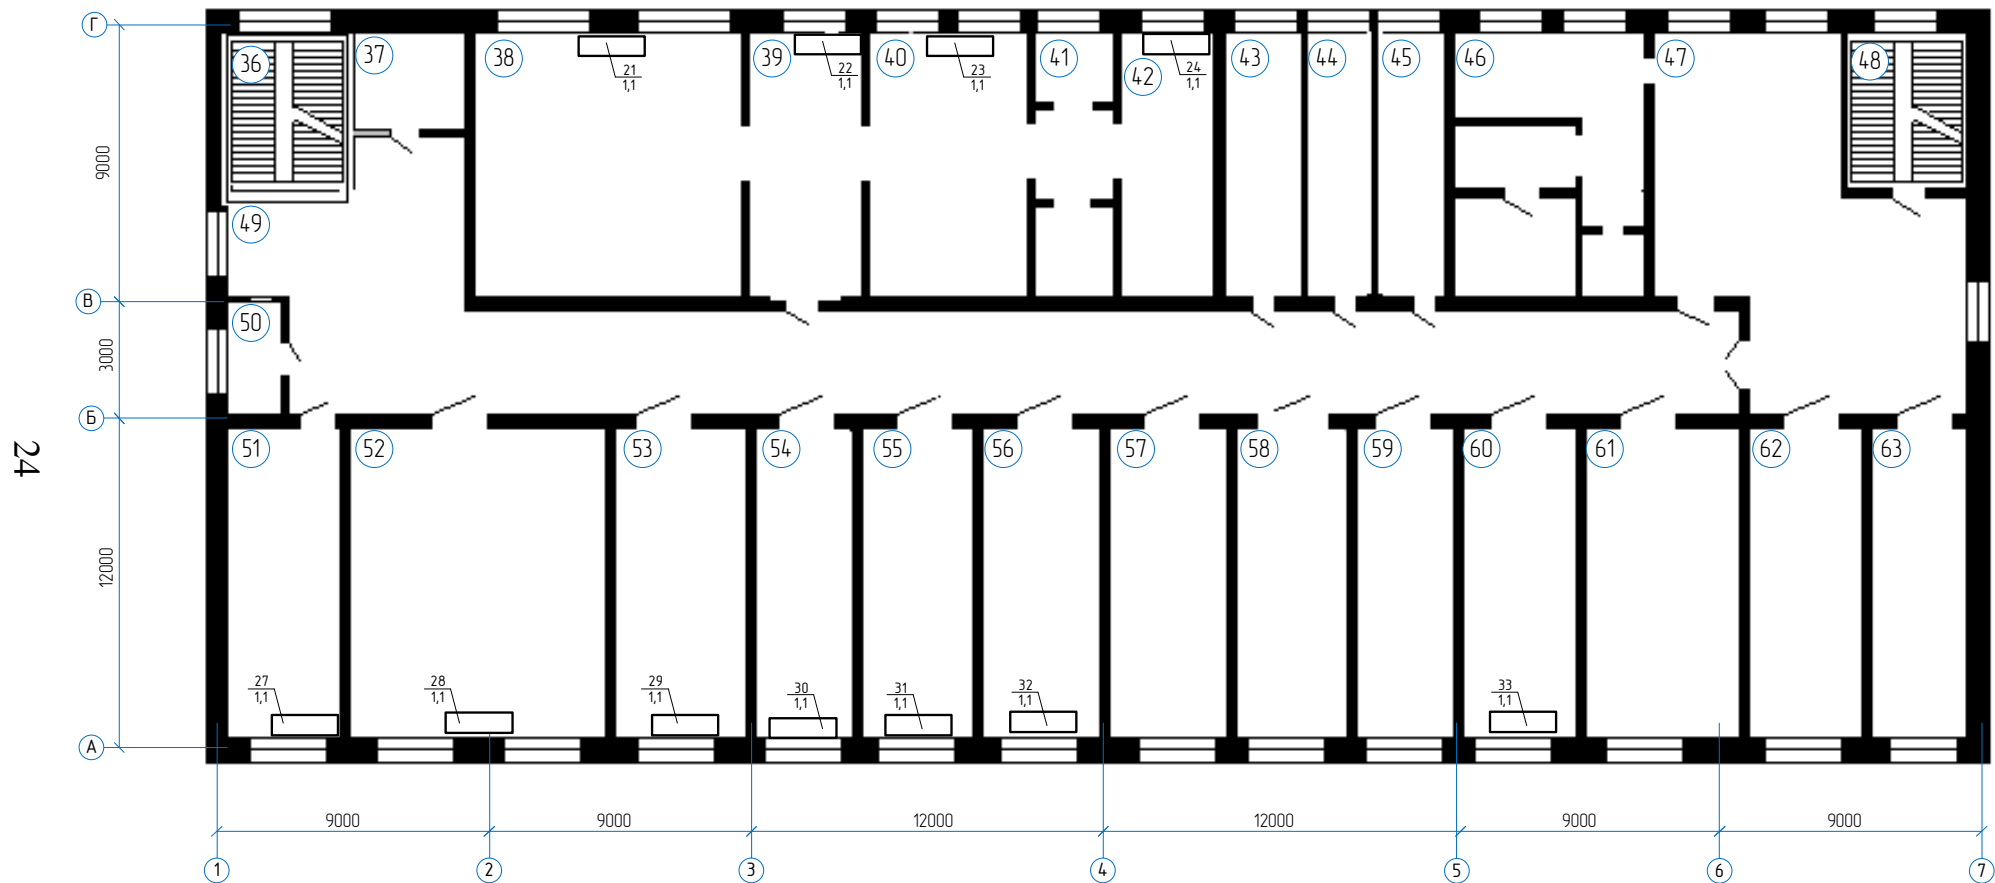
План расстановки электрооборудования на 2-м этаже
